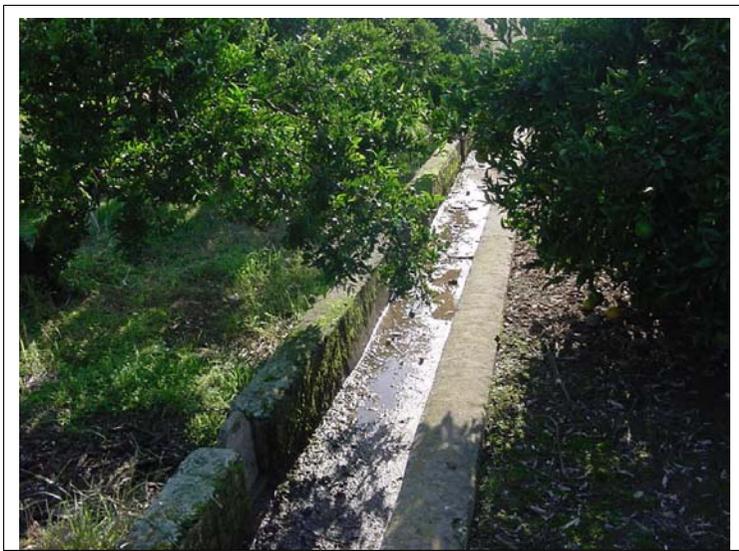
Acequia de dimensiones interiores 60x40 y murete de 20 cm.
